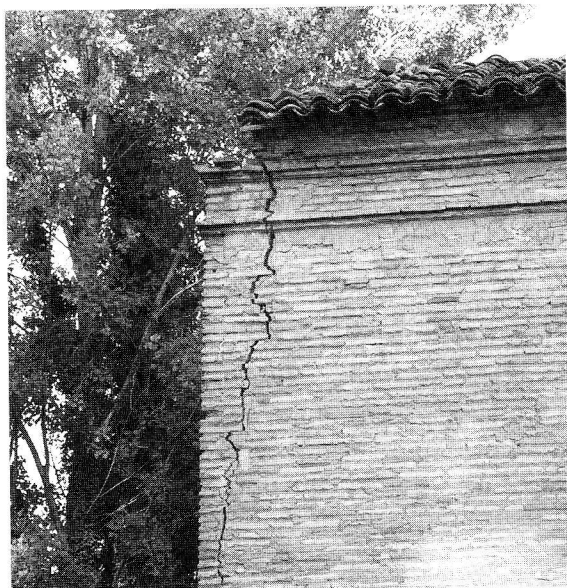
Detalle de la grieta existente junto al ángulo Suroeste
